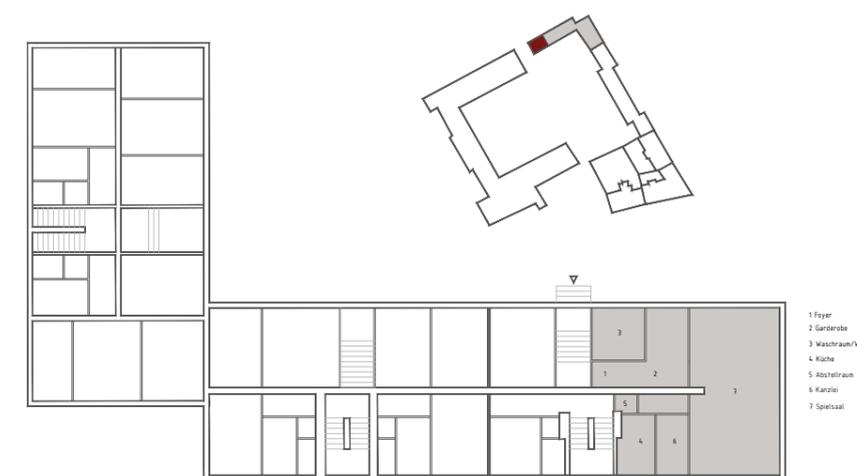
+ Abb. 14: Der Lageplan und Grundriss des Erdgeschosses des Bertha von Suttner Hofes in Wieden.
